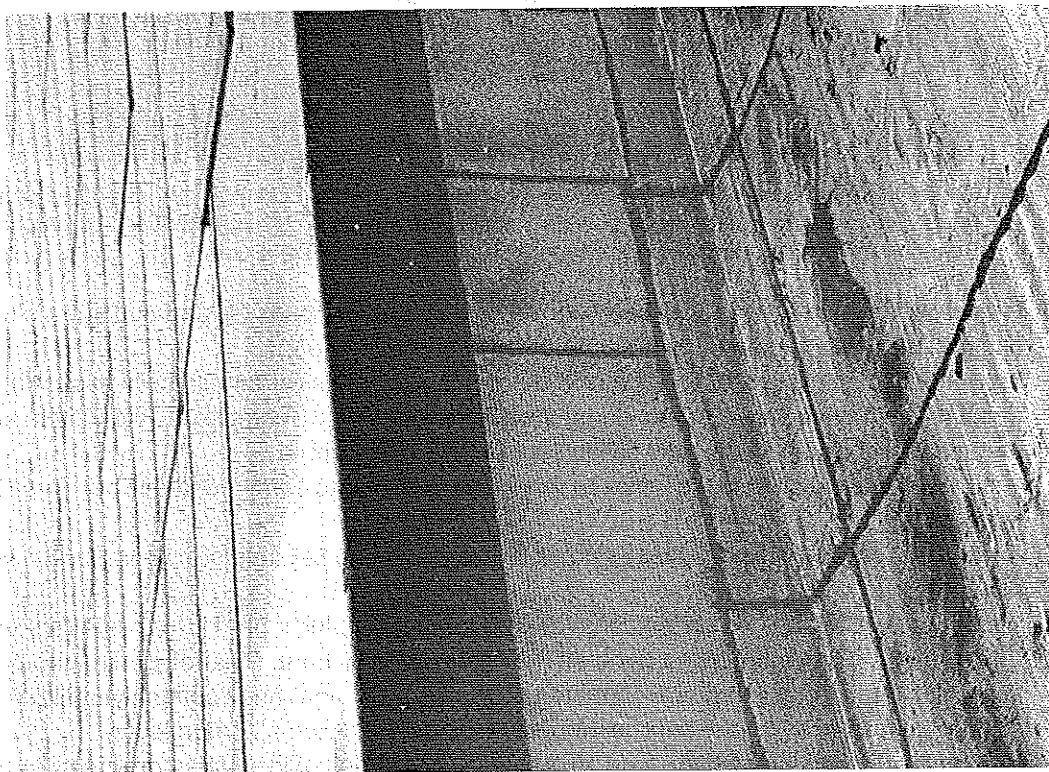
Détail zone centrale voûte concave. L'eau collectée dans la zone centrale de la voûte tombe en cascade sur plus de 1 m de hauteur. Aucune protection sur le chêneau autre que le revêtement autoprotégé qui présente un creux au droit de la bavette (tassement de l'isolant). © J. Putatti
